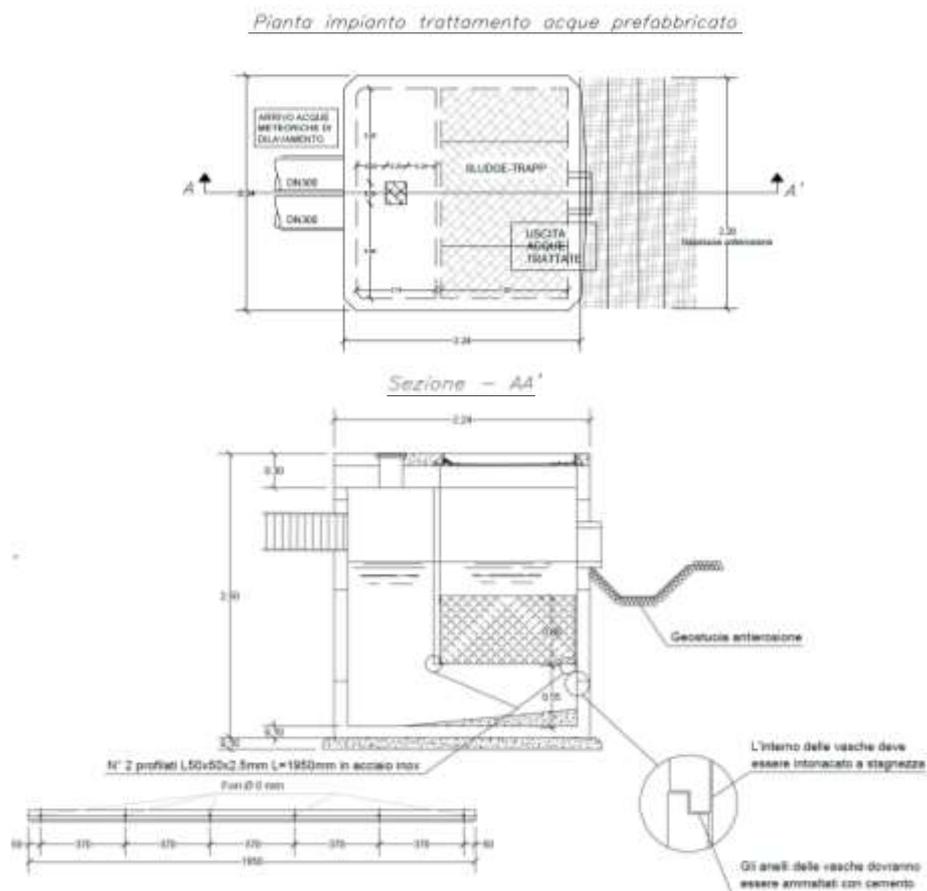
Pianta e sezione dell'impianto di trattamento
